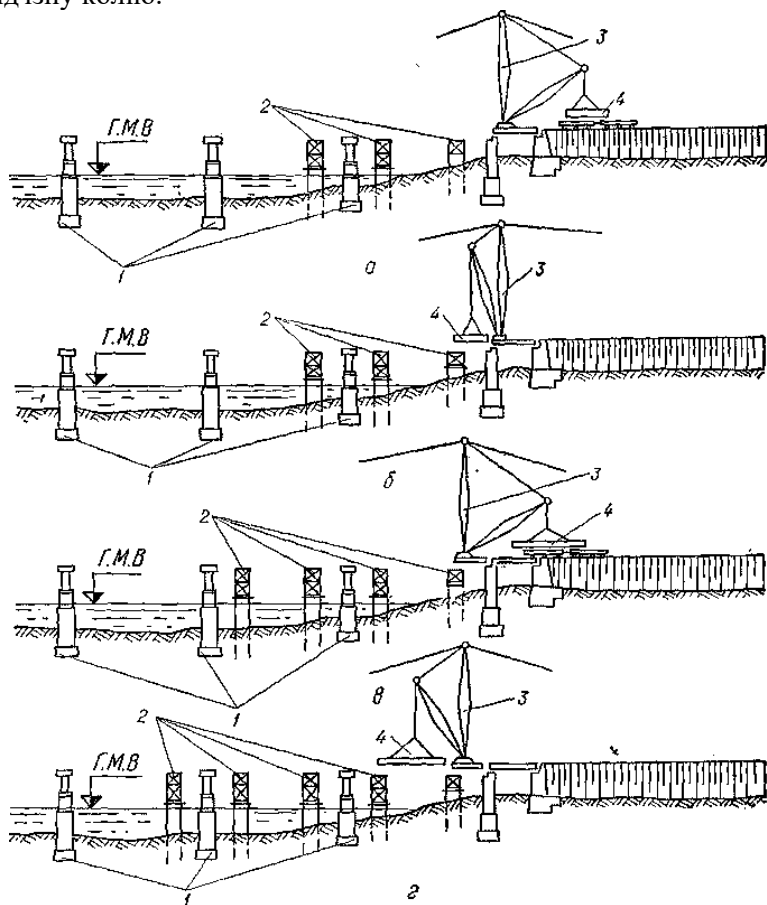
Схема прийнятого способу монтажу основних ферм прогонової будови:
